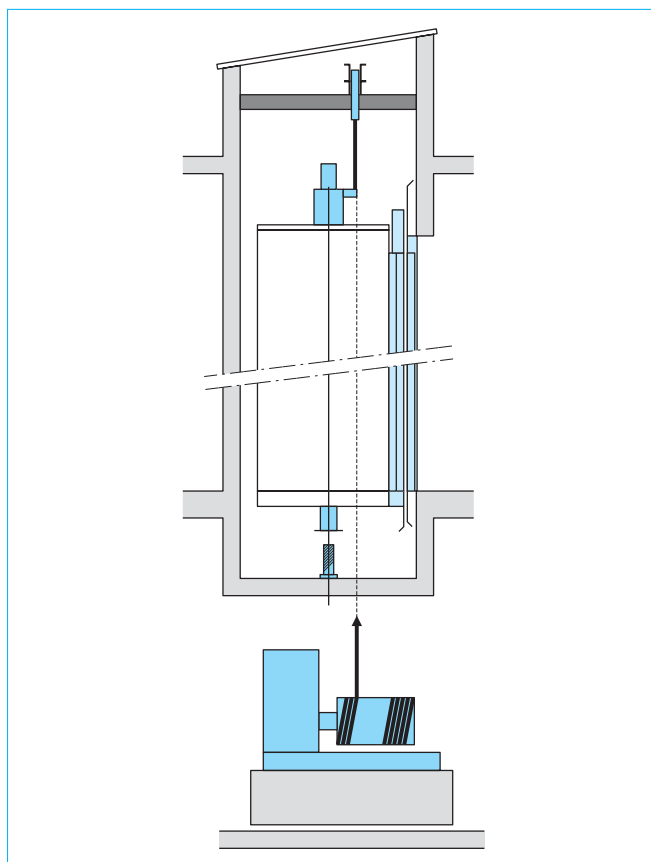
Installation à treuil attelé sans contrepoids (immeuble existant)
